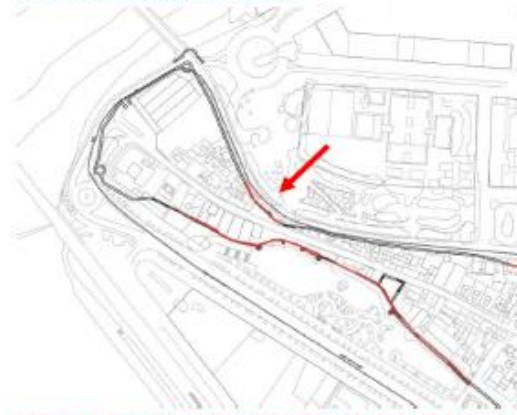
Plano de emplazamiento de la zona G. Fuente: Elaboración propia.
